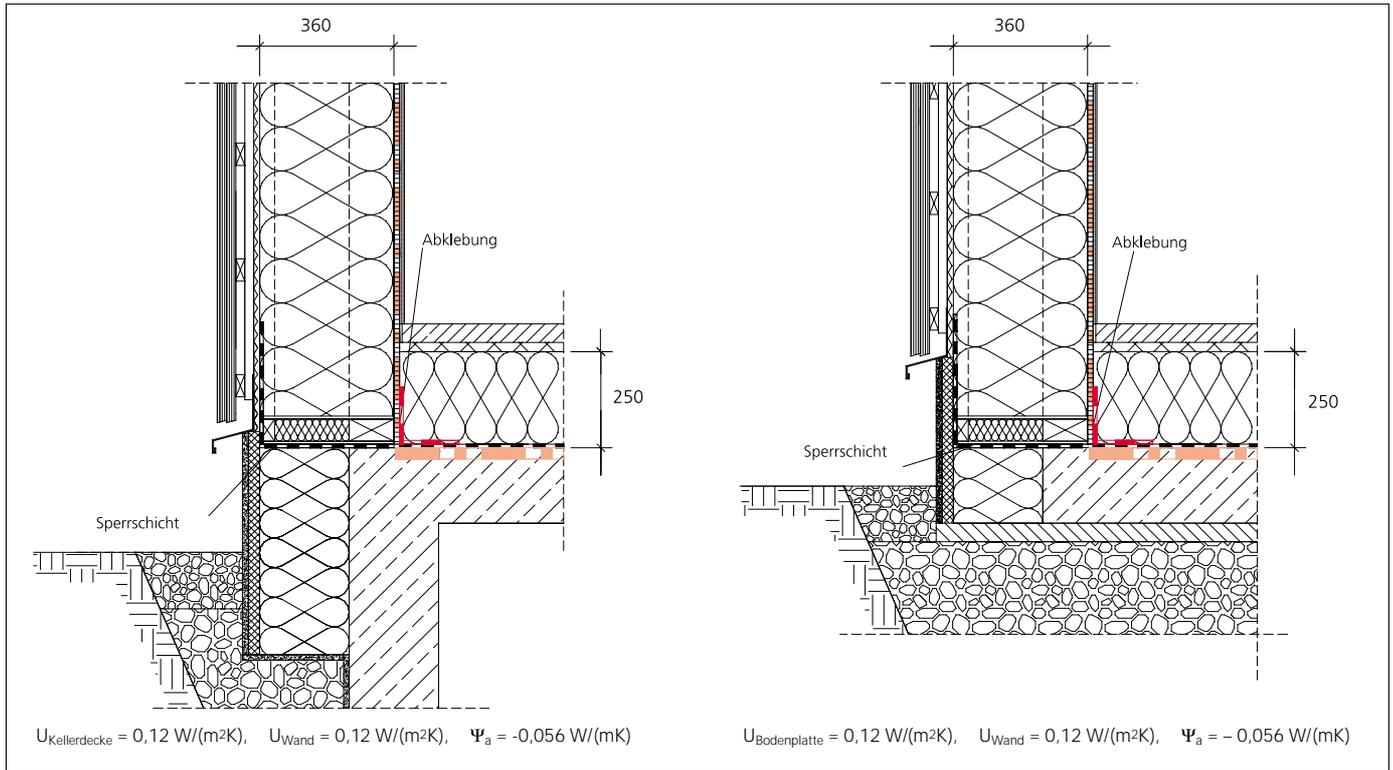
Außenwandschwelle auf Kellerdecke zum unbeheizten Keller, bzw. Bodenplatte mit innenliegender Dämmung. Beide Details entsprechen sich wärmetechnisch. Auf Sperrschicht gegen aufsteigende Feuchte achten.
